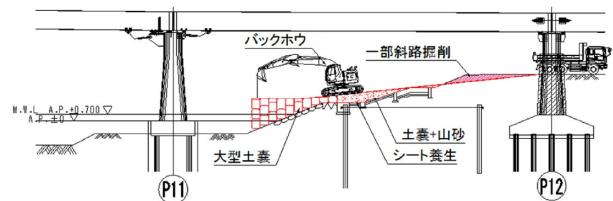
P11橋脚 作業土工施工図 (大型土嚢設置)
